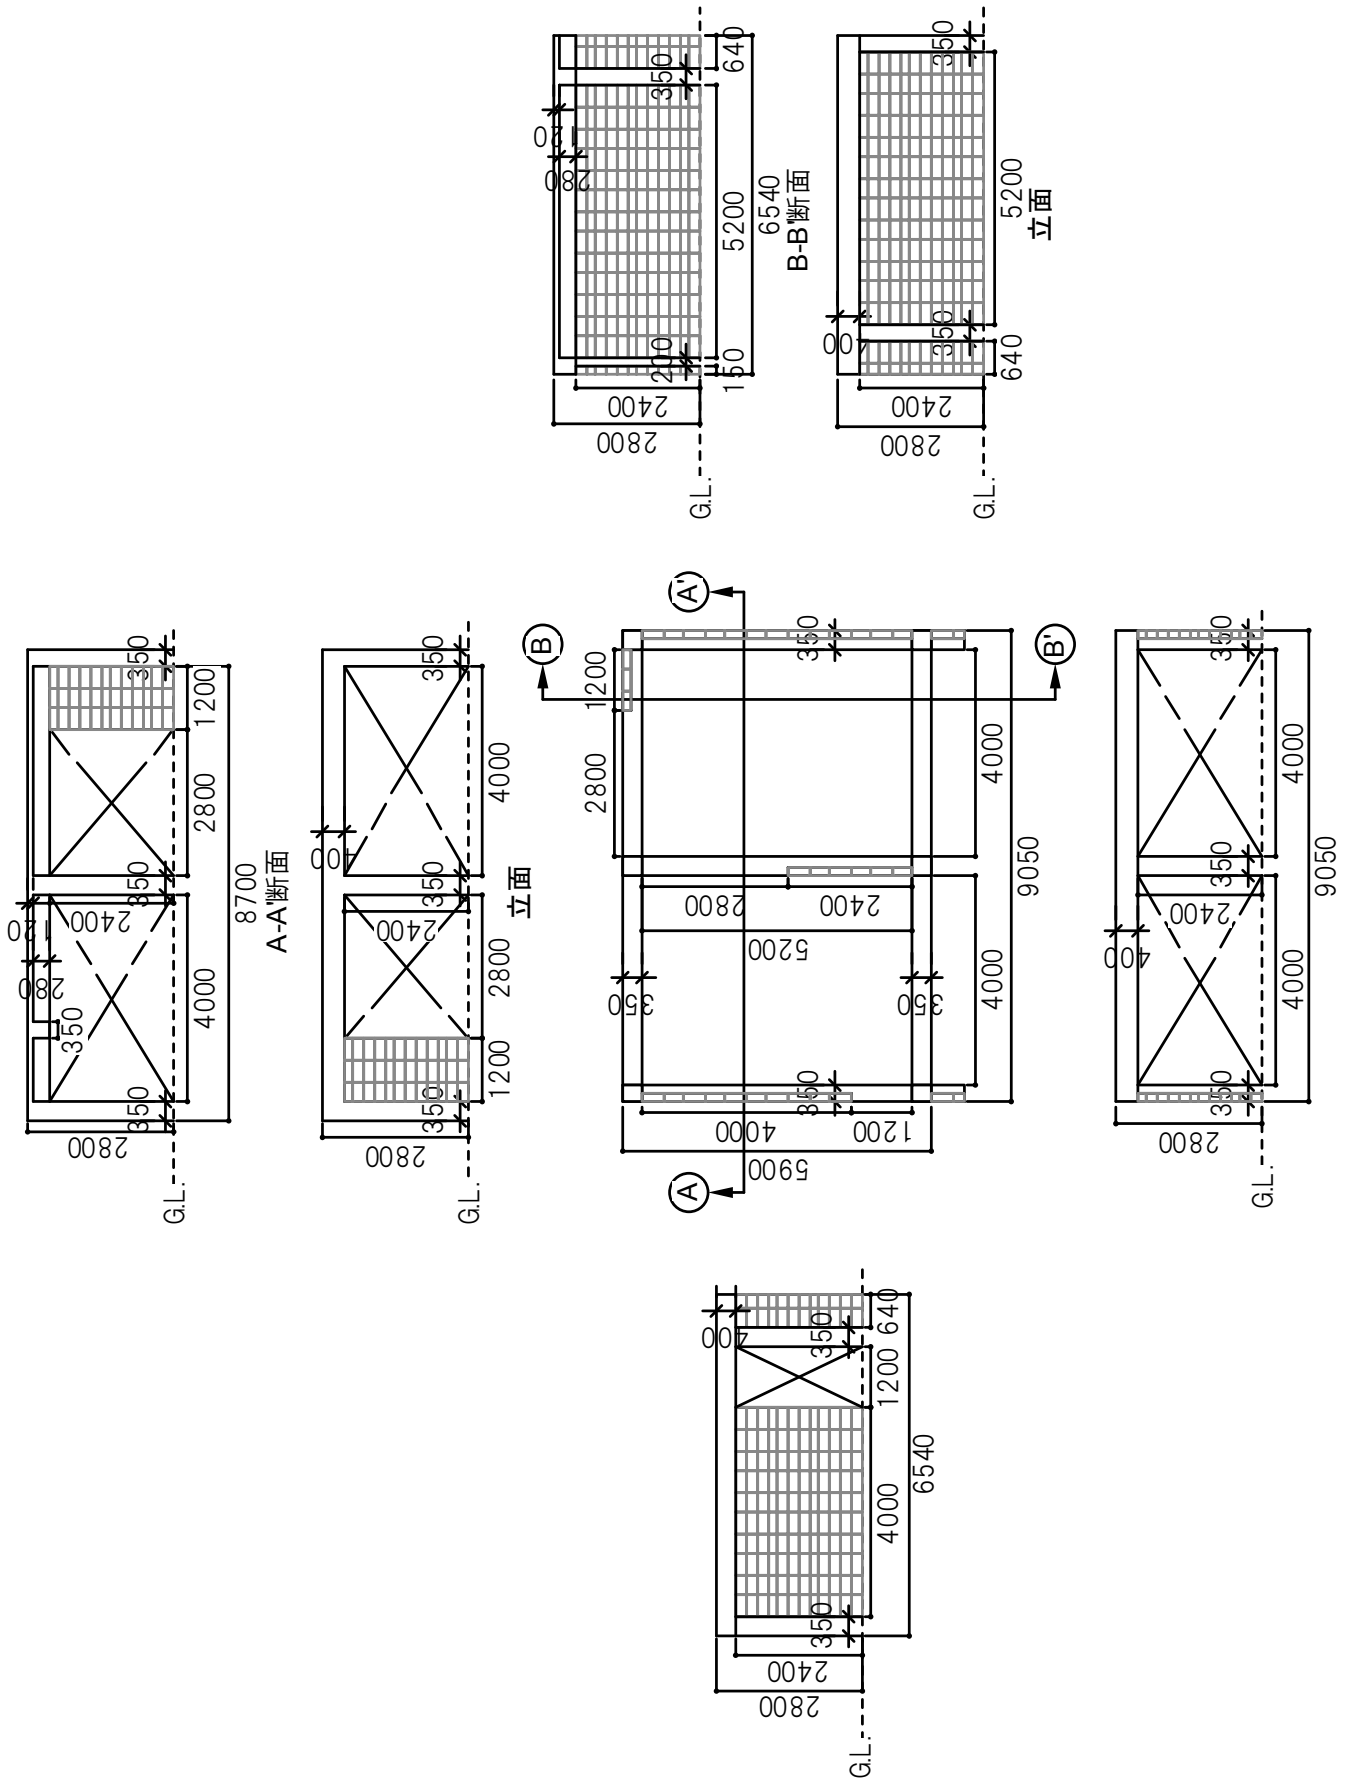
RC 造平屋住宅の立面図・平面図 (単位 : mm)
